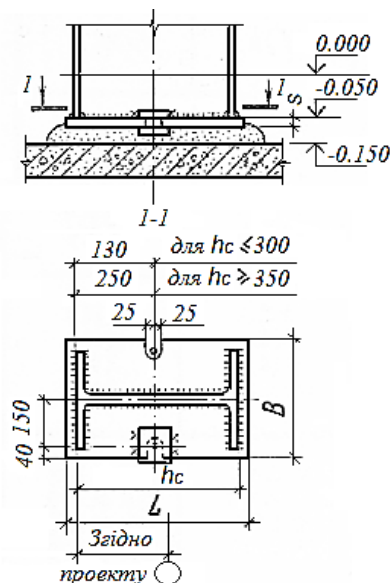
Вузол кріплення стійки фахверка до фундаменту
